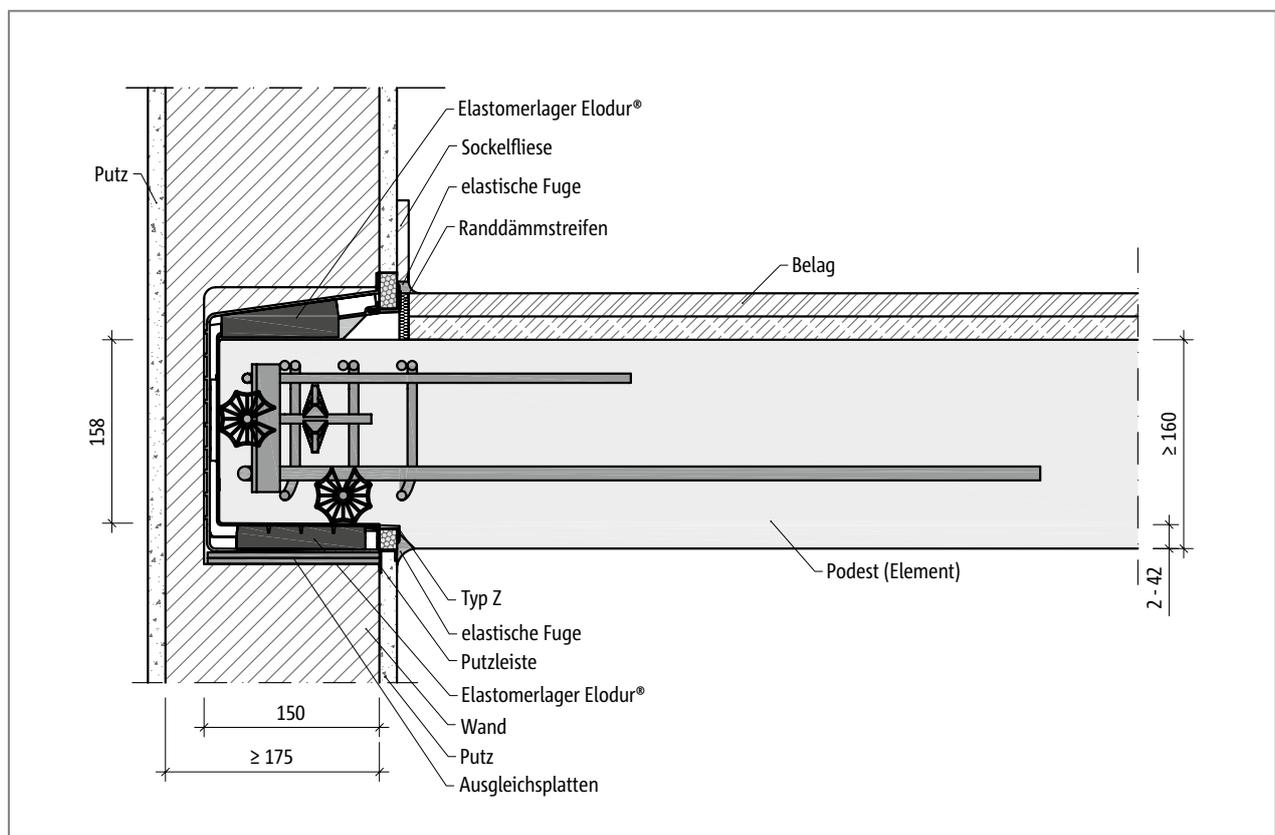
Schöck Tronsole® Typ Z-V+V-T: Einbauschnitt Fertigteilpodest
